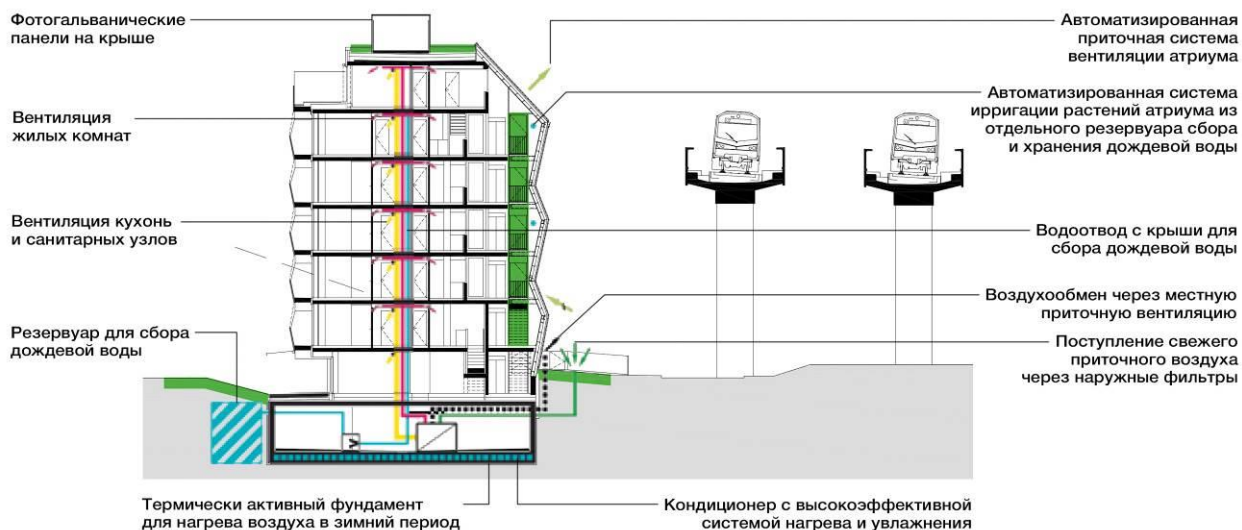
Поперечный разрез жилого дома в Вене с инженерно-конструктивными решениями систем жизнеобеспечения
